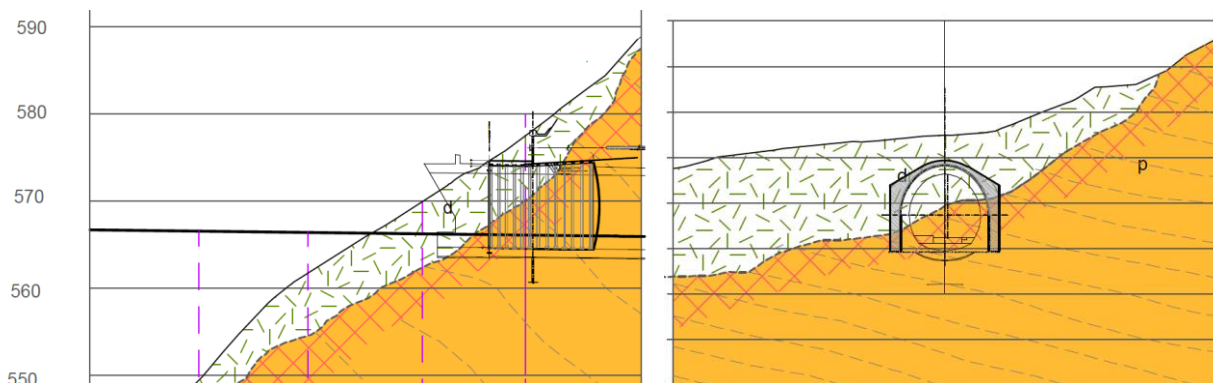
Stralcio del planoprofilo di dettaglio dell’imbocco Gardena Nord, (elaborato IB0U1BEZZL7GE0001004C) con le due sezioni longitudinale e trasversale lungo il binario pari.
